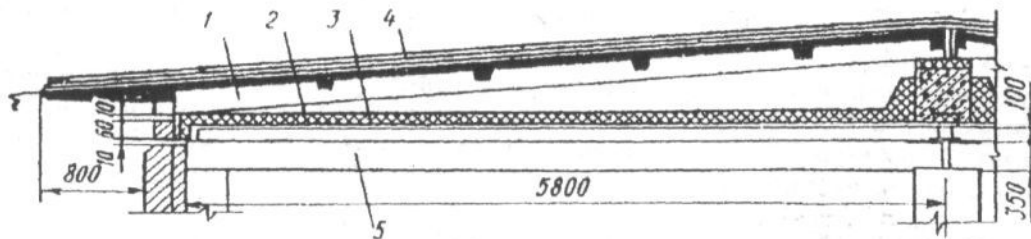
Конструкция бесчердачной вентилируемой совмещенной крыши
